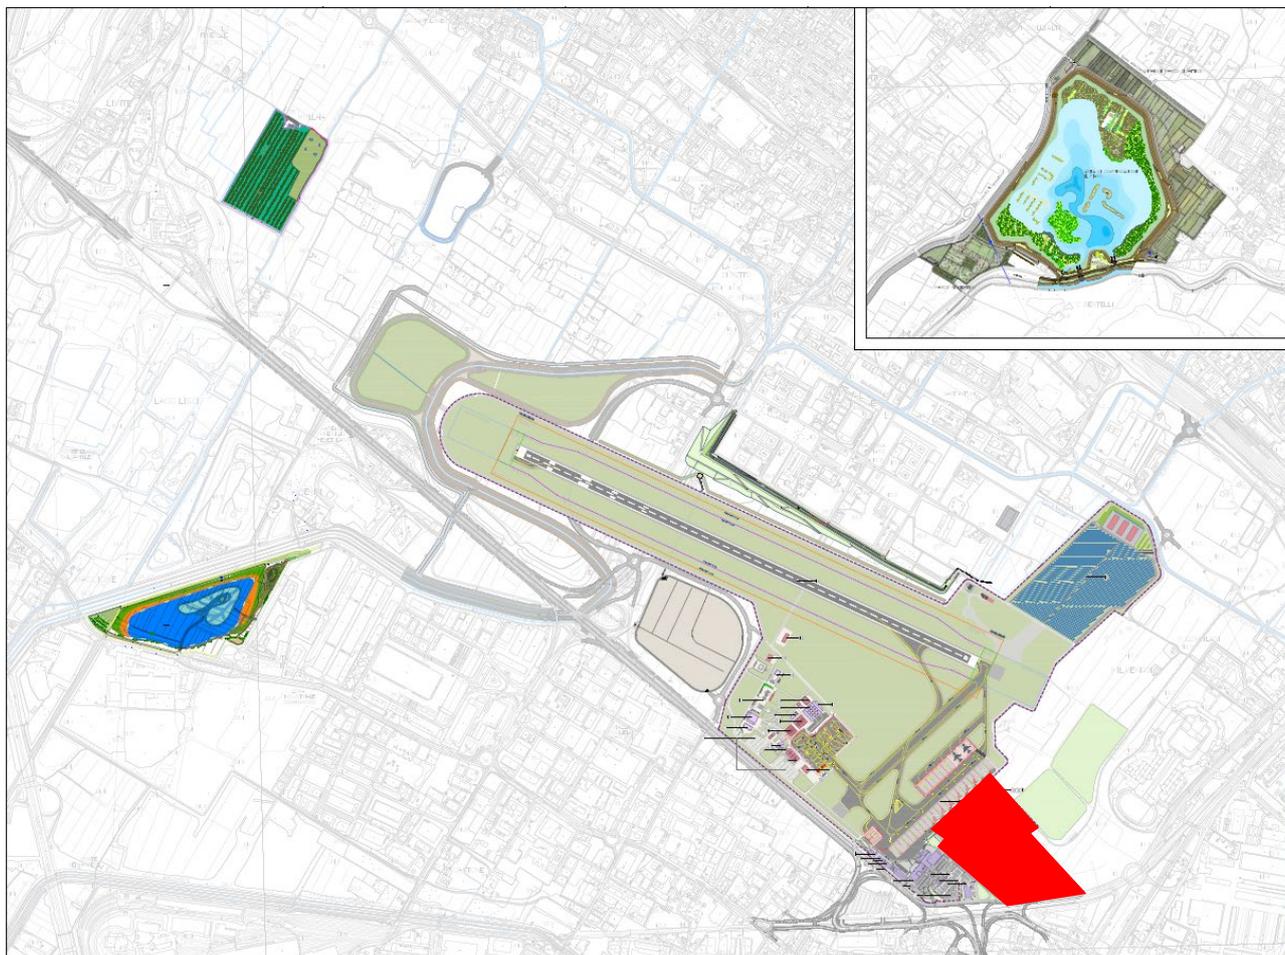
Ipotesi Masterplan con individuazione dell'area Est
